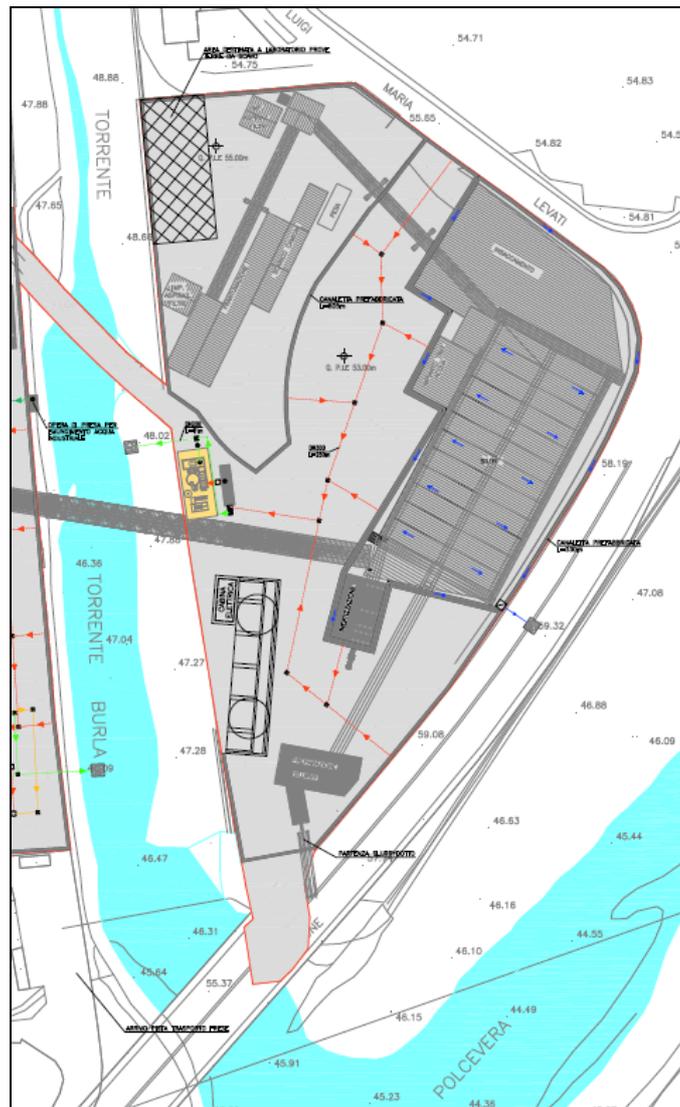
Stralcio planimetrico del cantiere CI14 (da elaborato CAP0321 del PD)
